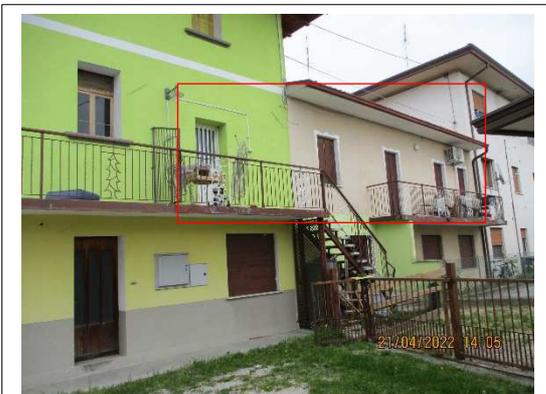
dettaglio prospetto Sud-Ovest abitazione
